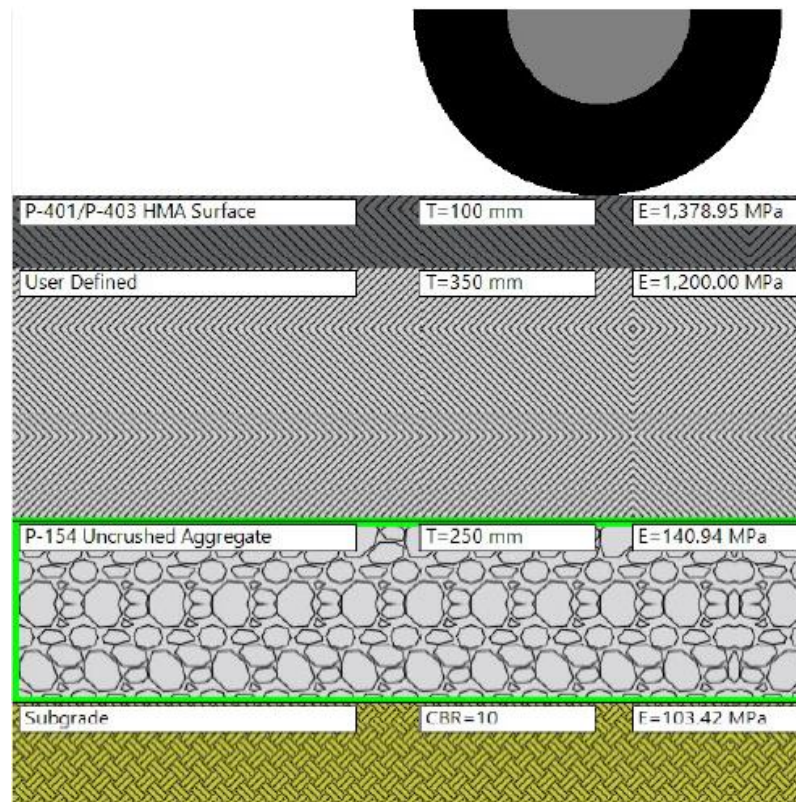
Estructura de Pavimentó SKCG. Fuente: FAARFIELD v2.1.1
